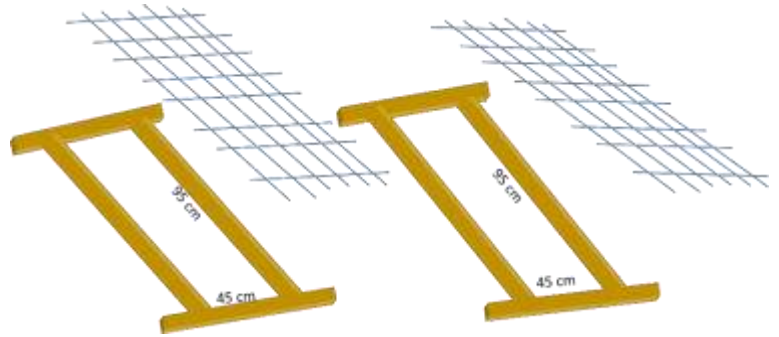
Armado de la cimbra para la construcción de tapas de las cámaras del baño
